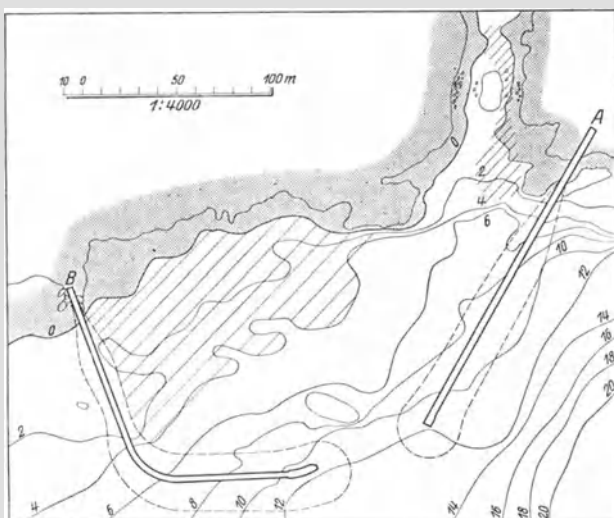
Bucht von Kjaerringholmen. Rundö.
